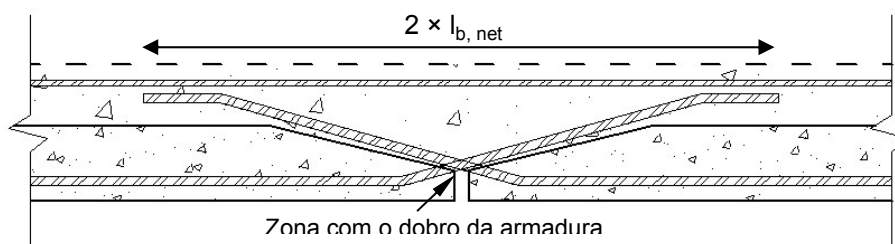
Ligação laje – laje entre duas pré-lajes maciças
